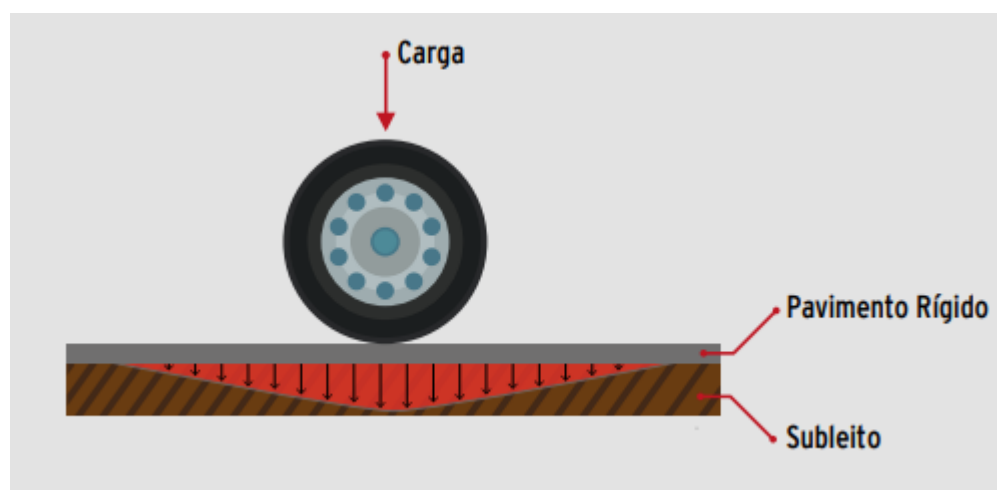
Distribuição de carga em pavimento rígido (CNT, 2017)
